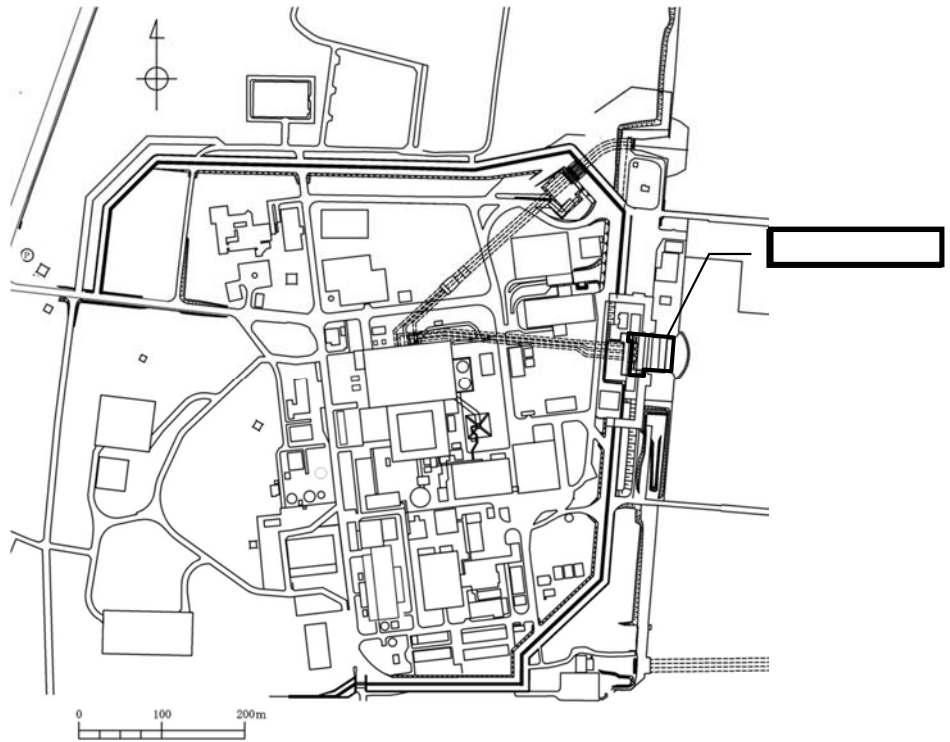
(1) 取水構造物の平面配置図（全体平面図）
